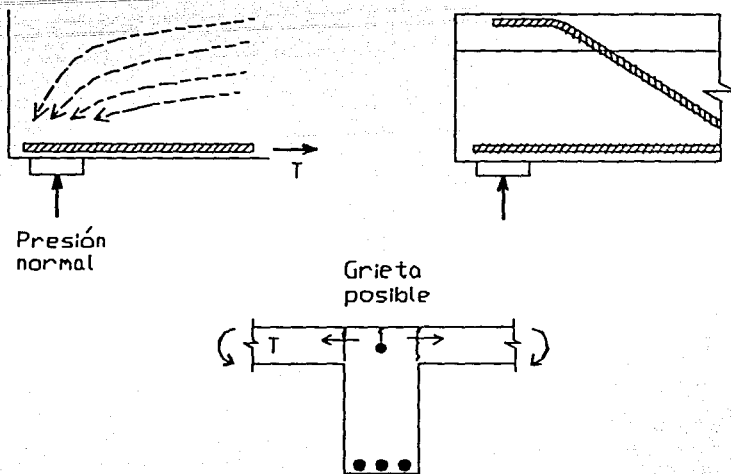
Presión o tensión transversal en el anclaje del refuerzo de viga. (1.1)
